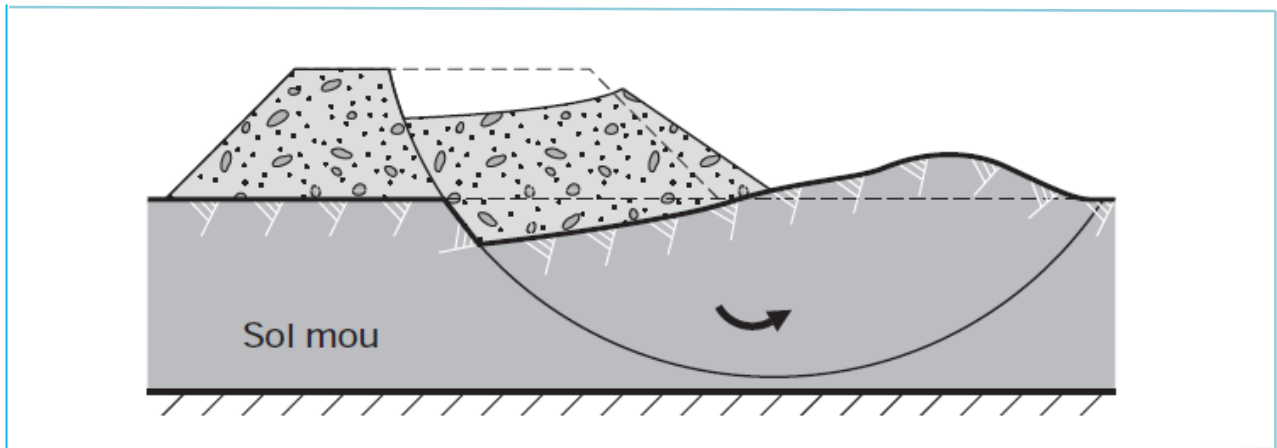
Glissement avec fissuration (Magnan et al, 1984).
